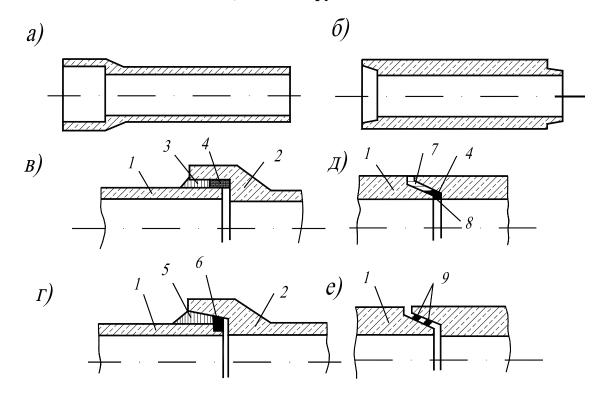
Бетонные и железобетонные трубы и способы их соединения:
